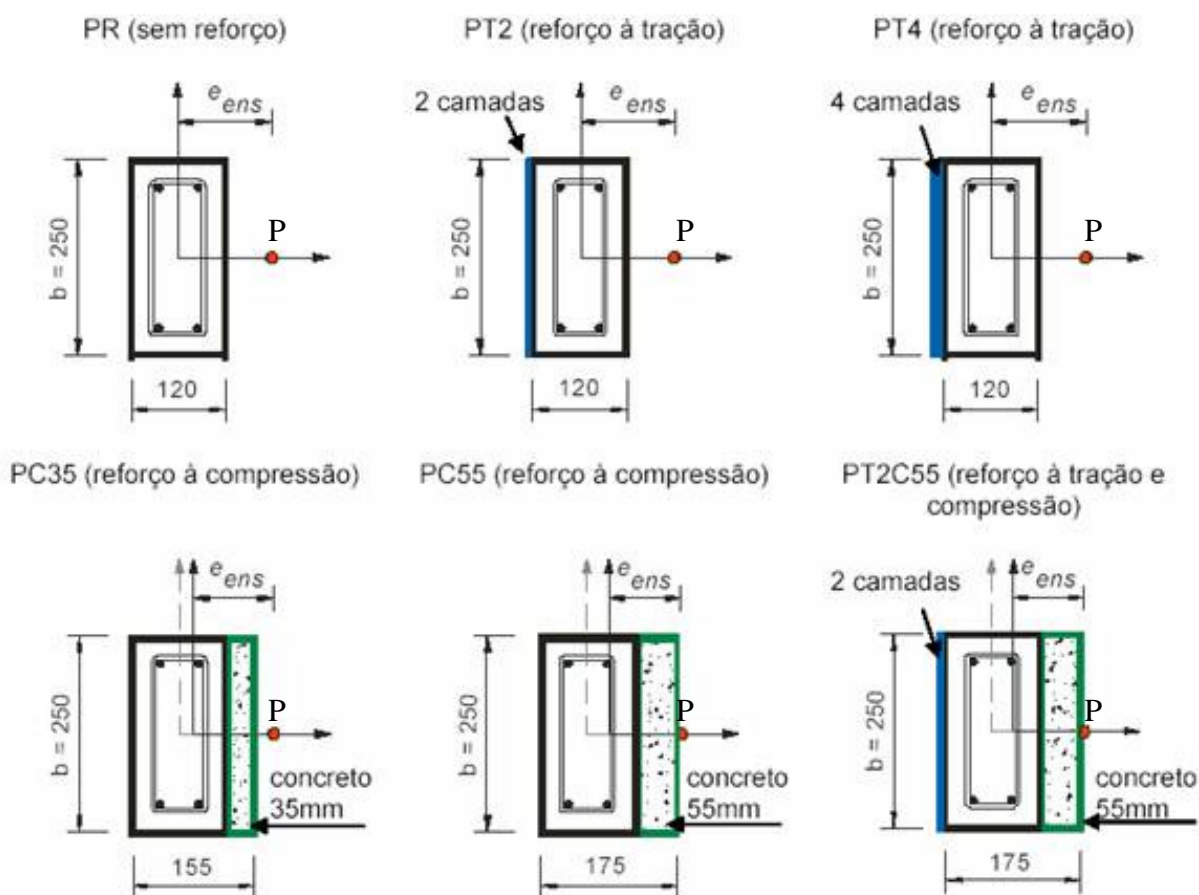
Seção transversal das peças ensaiadas (GOMES et al, 2007)
